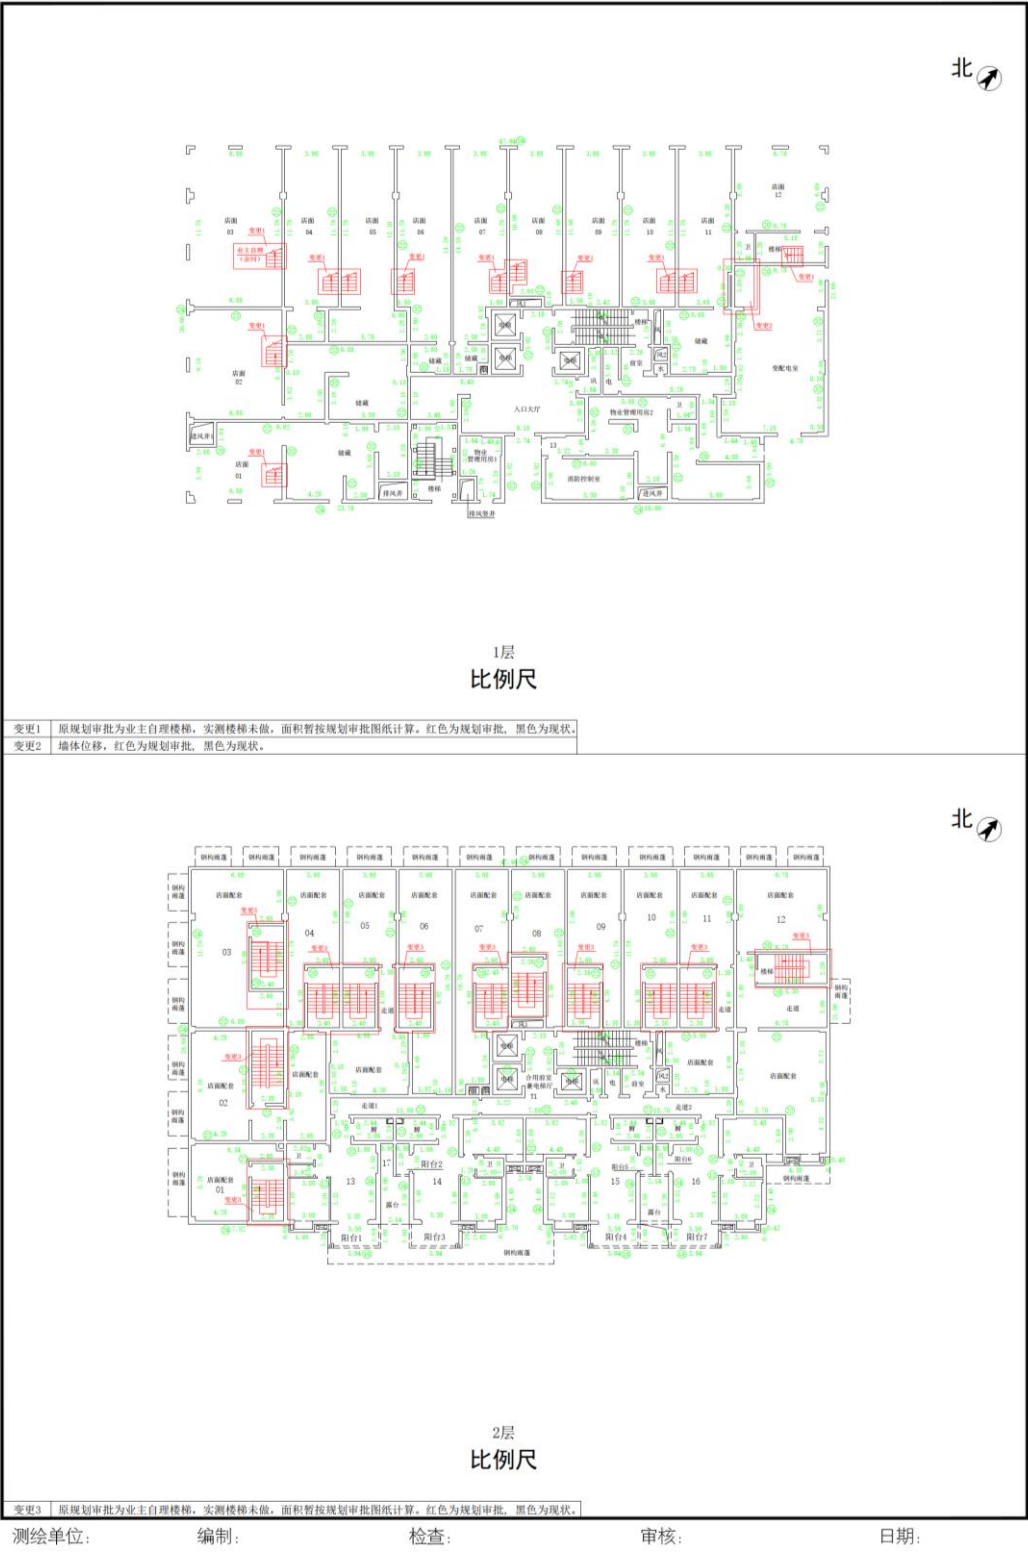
竣工分层平面图与规划许可不一致对照示意图
